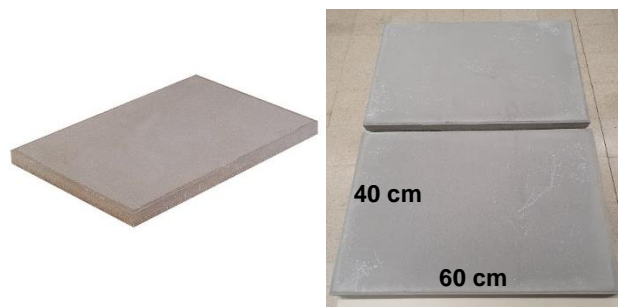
Lajetas de betão adquiridas da Leroy Merlin (Leroy Merlin, 2022).
